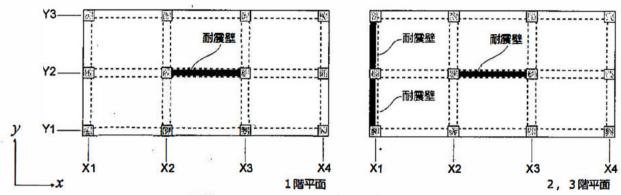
鉄筋コンクリート造架構の平面図(床梁伏図)
